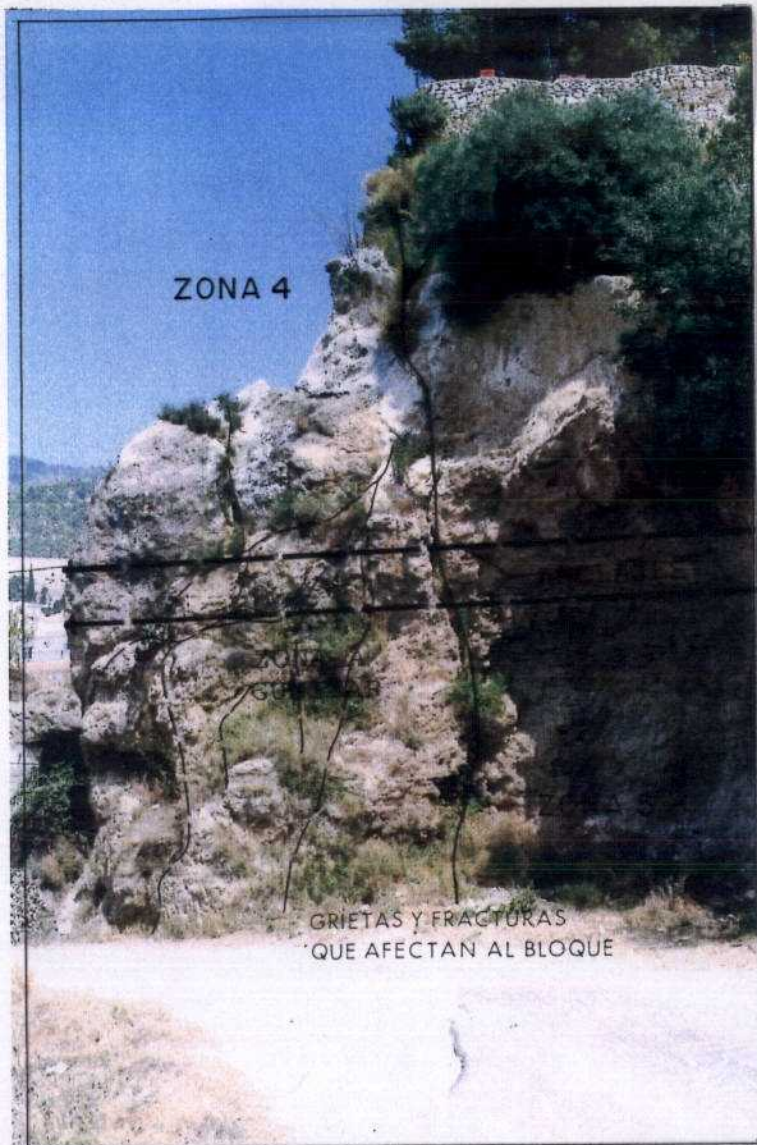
Base del bloque inestable de la Zona 4, sobre la que apoya un pequeño canal que aparece fracturado. Vista del lado W.
